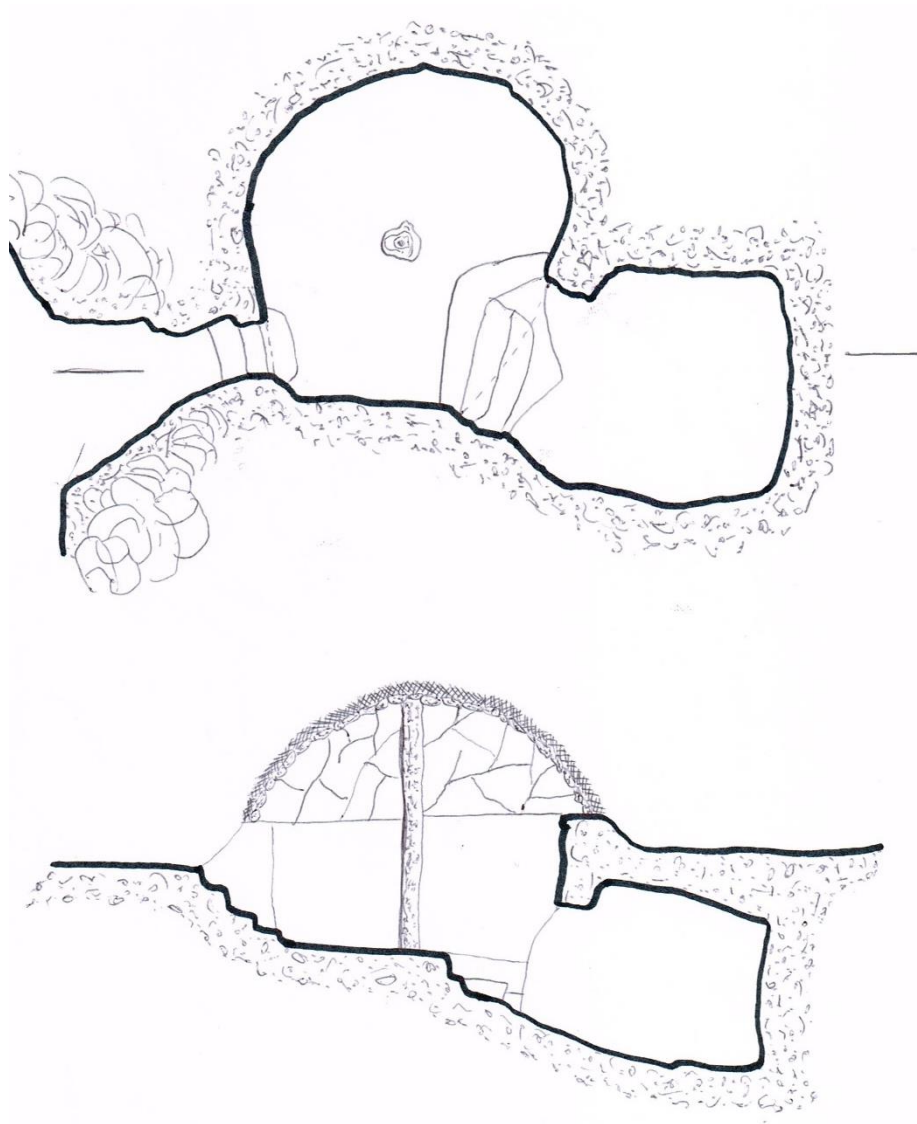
Plan et coupe de la hutte. (Source : D'après Louis, 1975 : 241)
